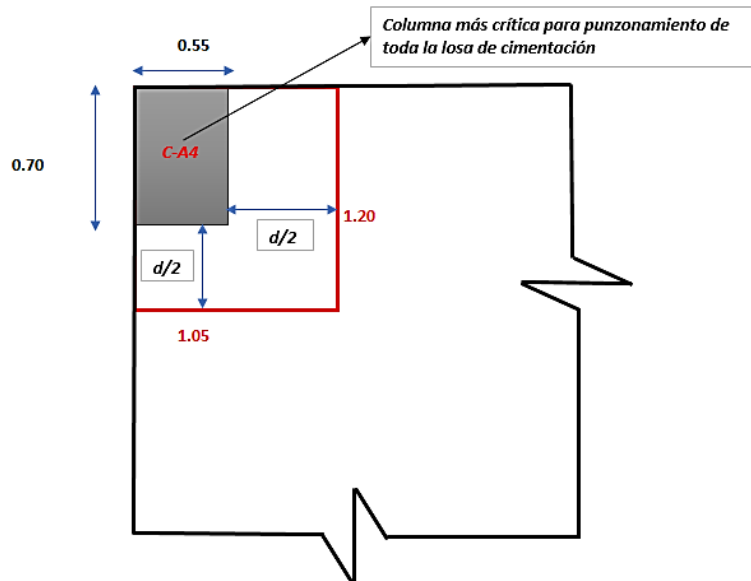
Sección crítica de punzonamiento para la columna "C-A4"
